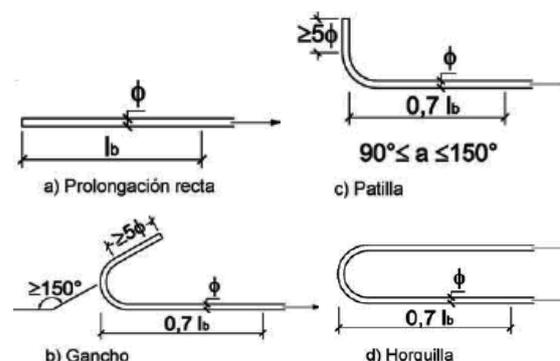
Anclaje de las armaduras incluidas en la fábrica.
